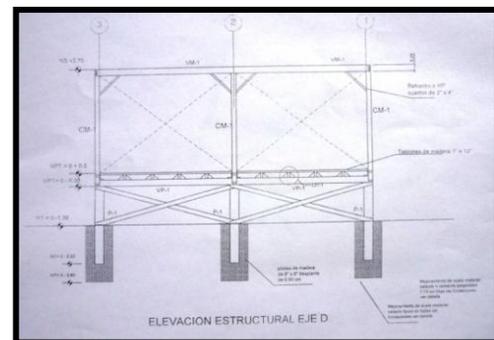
elevación estructural que muestra el sistema constructivo de la vivienda nueva en Kuakuil.
